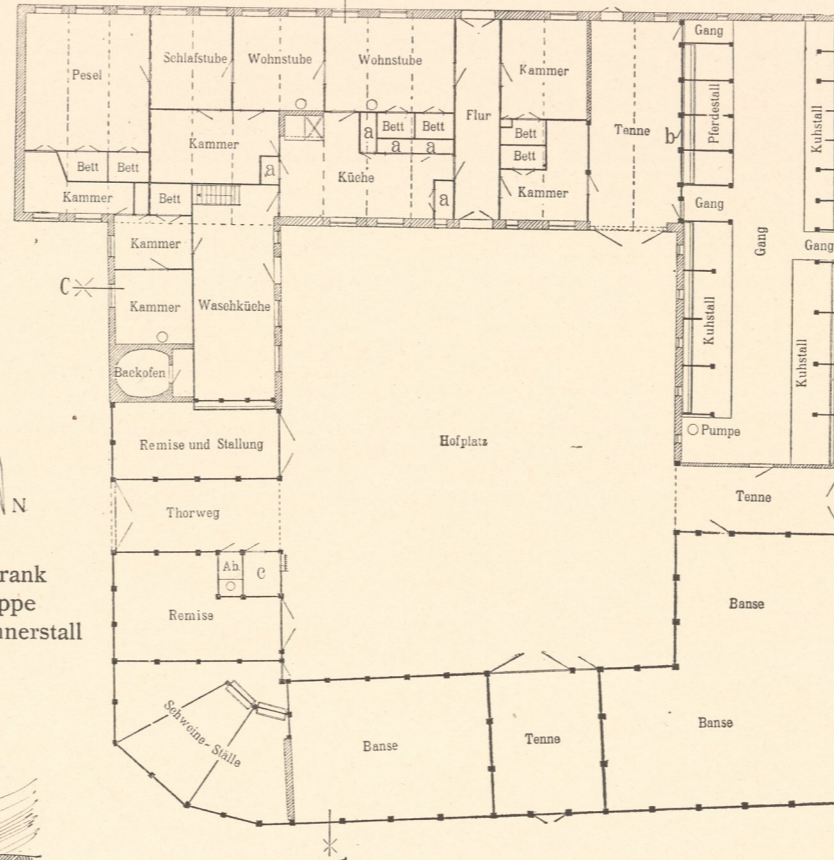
Bauernhaus in Barsmark, Kreis Apenrade. 1:300.
